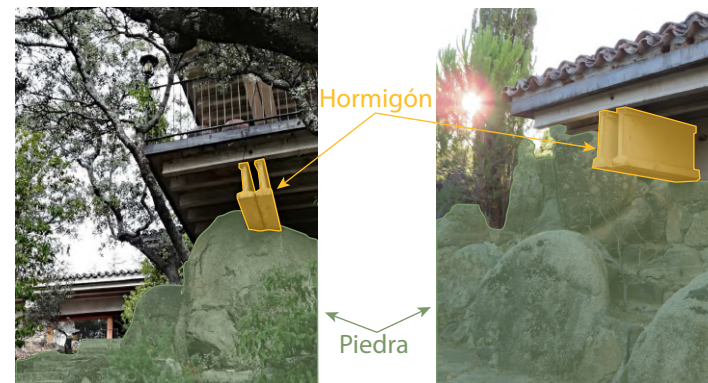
y 3\_Uniones viga de hormigón-piedra
